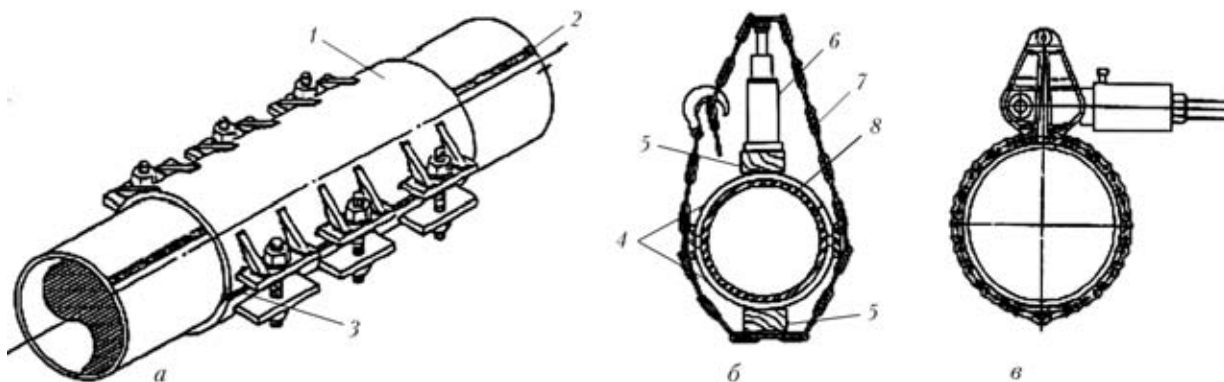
Схематическое изображение механических способов обеспечения прилегания муфты к стенке трубы [2]: a — болтовой; b — стандартный; $в$ — с защемлением цепи; 1 — ремонтная муфта; 2 — продольный сварной шов; 3 — сварной шов с полным проплавлением и сплавлением с подложкой (наиболее употребимы два симметрично расположенных соединения); 4 — половины муфты с боковыми опорами; 5 — деревянная опорная рама; $б$ — гидравлический пресс; 7 — высокопрочная цепь; 8 — ремонтируемый трубопровод
